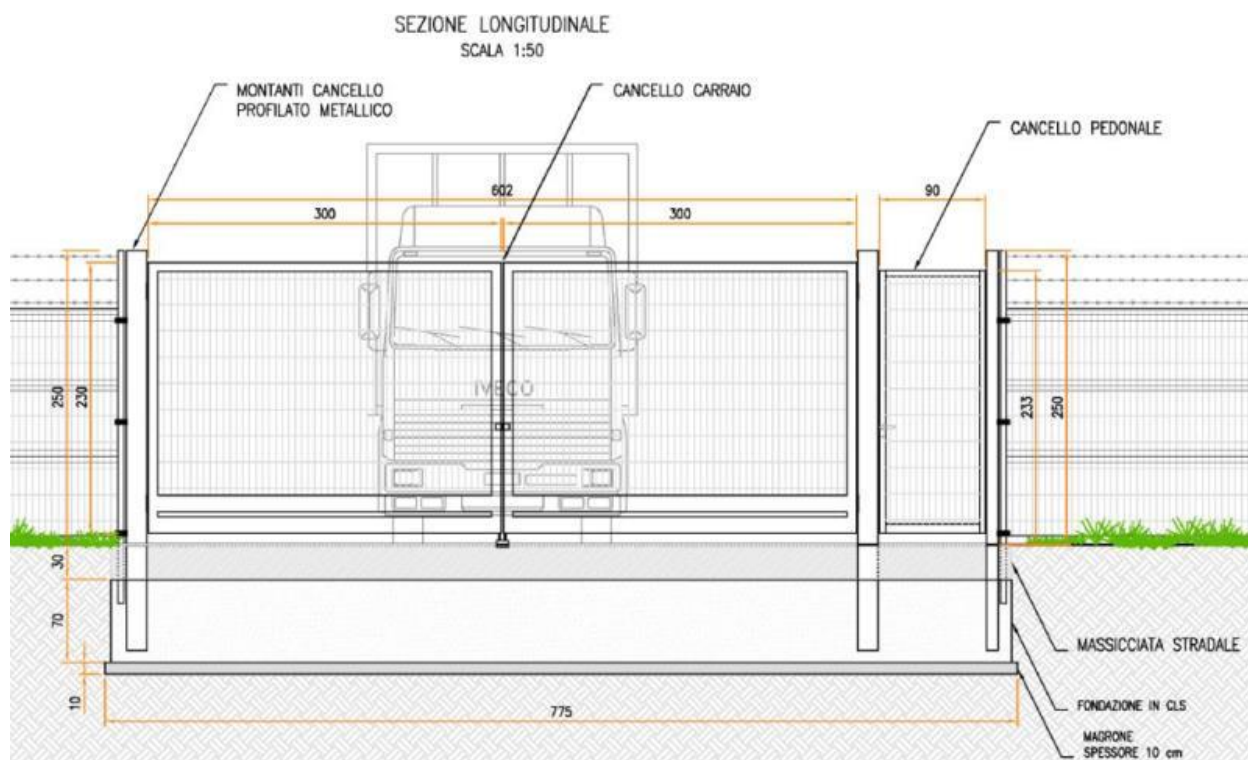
Sezione longitudinale accesso carraio e pedonale
